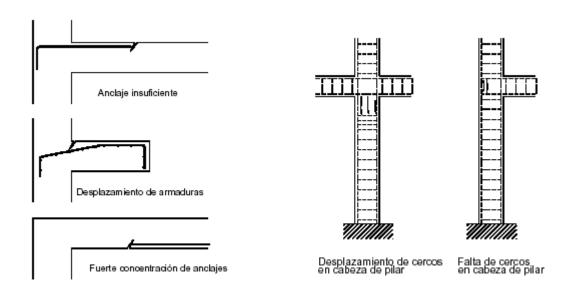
Fisuración por mala disposición de armadura
